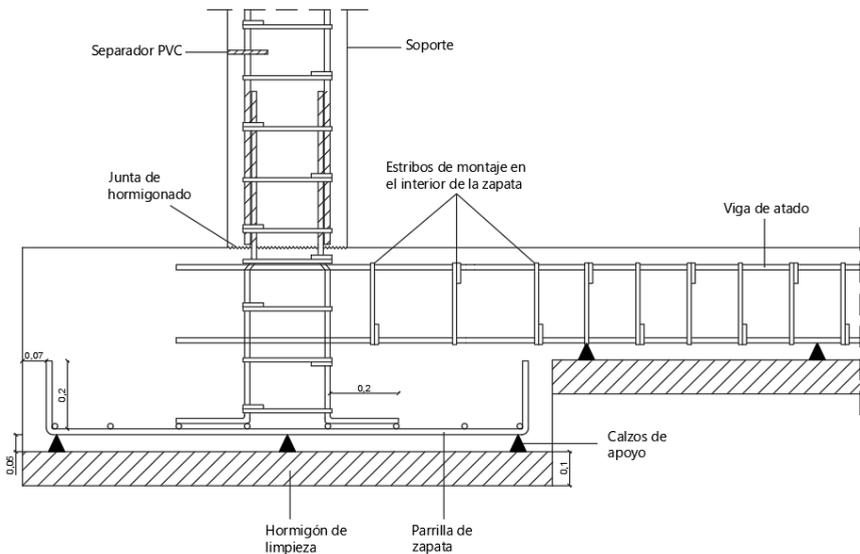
Detalle zapata aislada arriostrada. (Elaboración propia, 2023).
